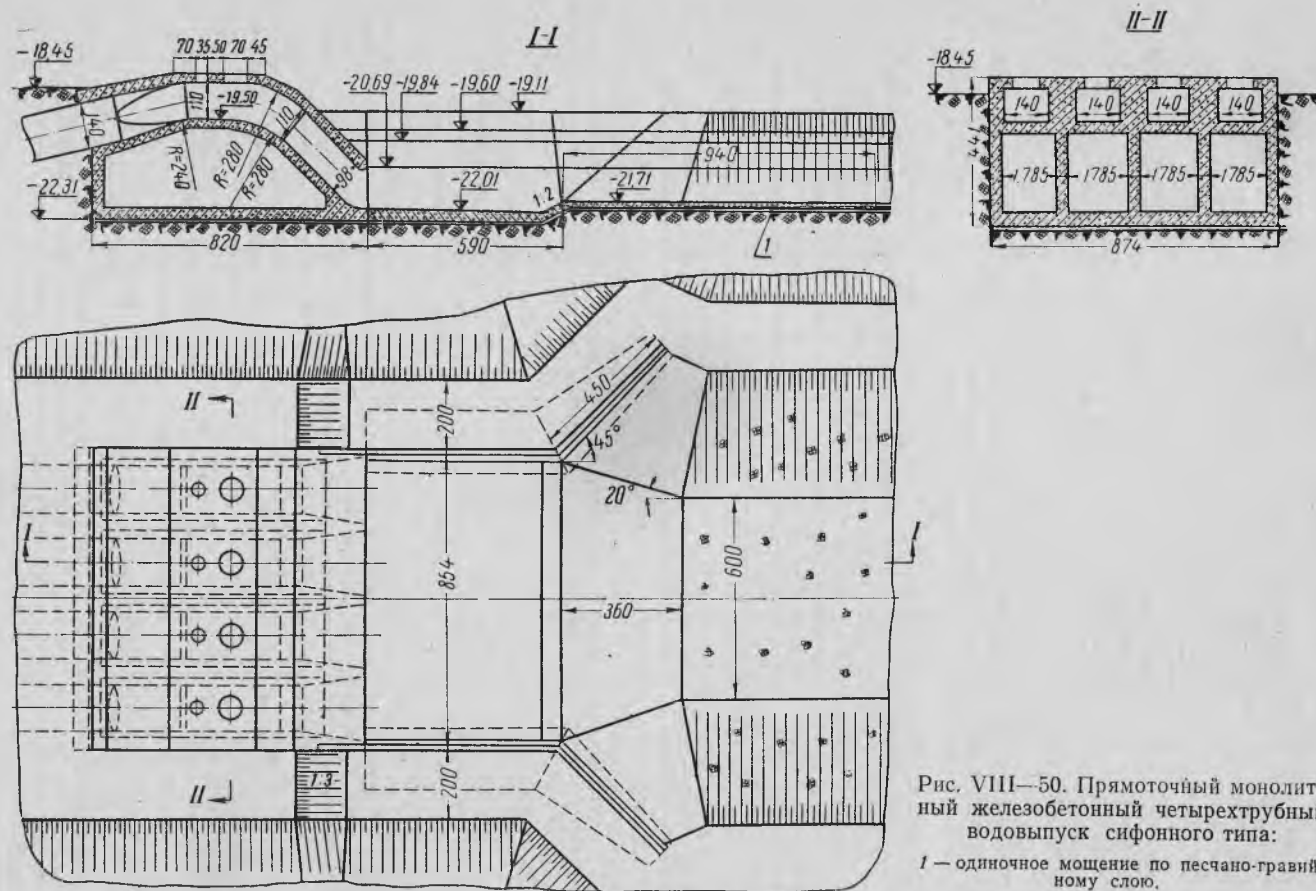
Прямоточный монолитный железобетонный четырехтрубный водовыпуск сифонного типа:
